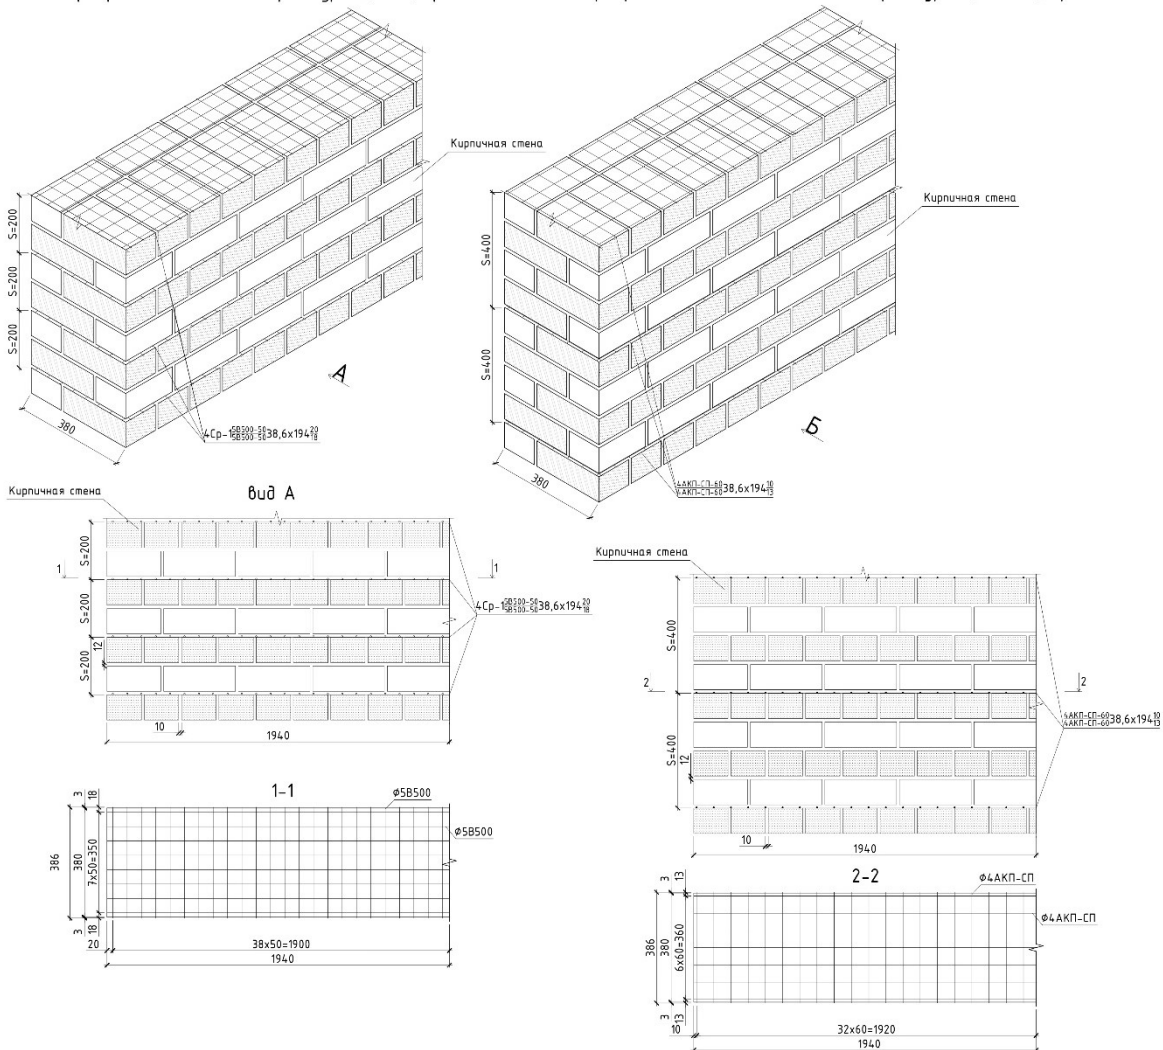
Схемы армирования стальной арматурой (В500) и стеклопластиковой (АКП-СП) простенка
